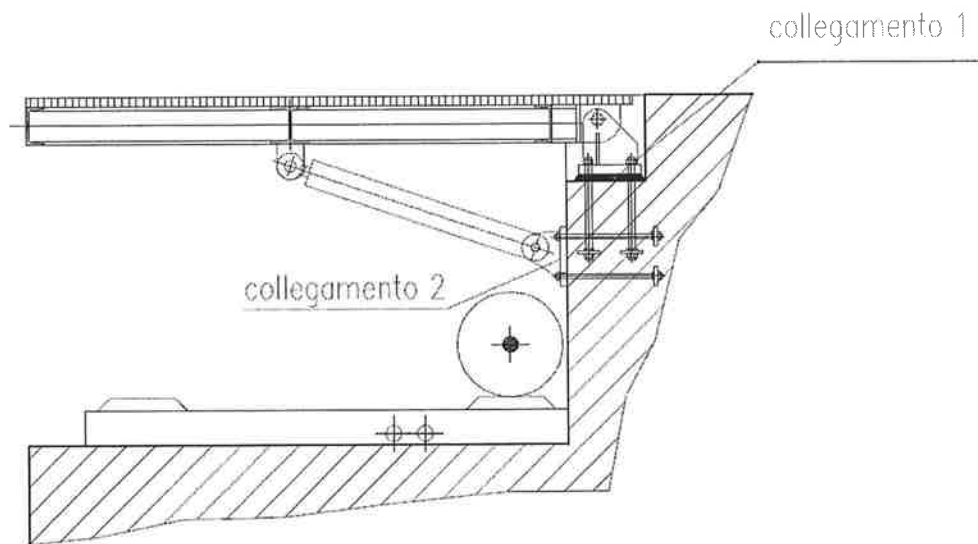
COLLEGAMENTI PENSILINA - CALCESTRUZZO
